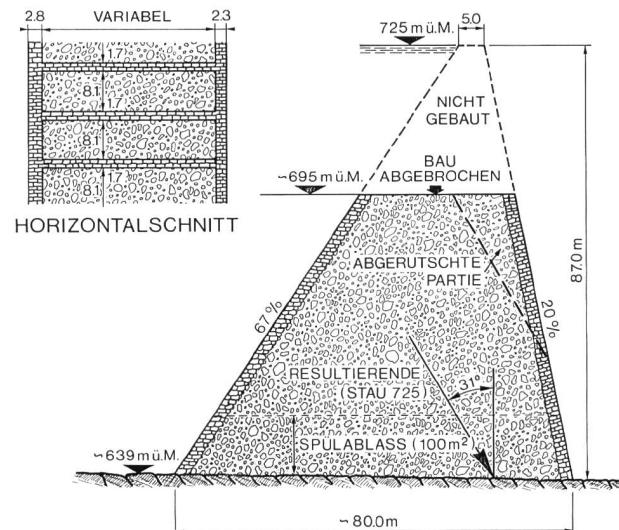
Vertikal- und Horizontalschnitt der 1787 begonnen, 87 m hoch geplanten Staumauer Gasco westlich von Madrid.
